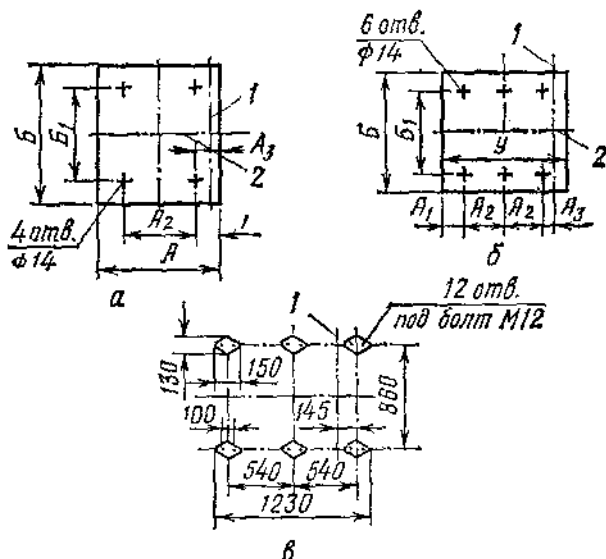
Расположение отверстий в перекрытии для вентилятора типа ВПЗ:
